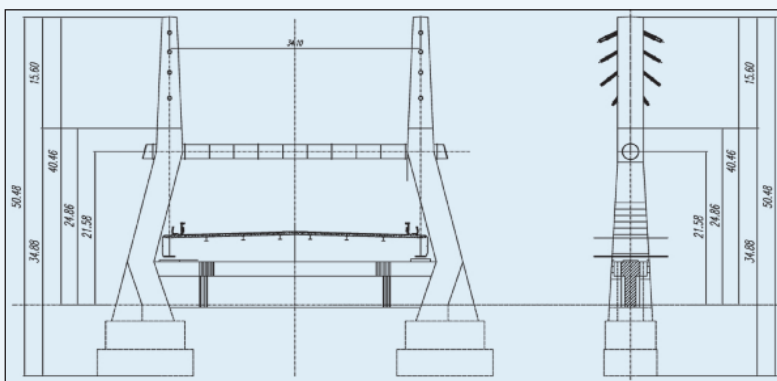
La sezione trasversale e longitudinale dell'antenna
